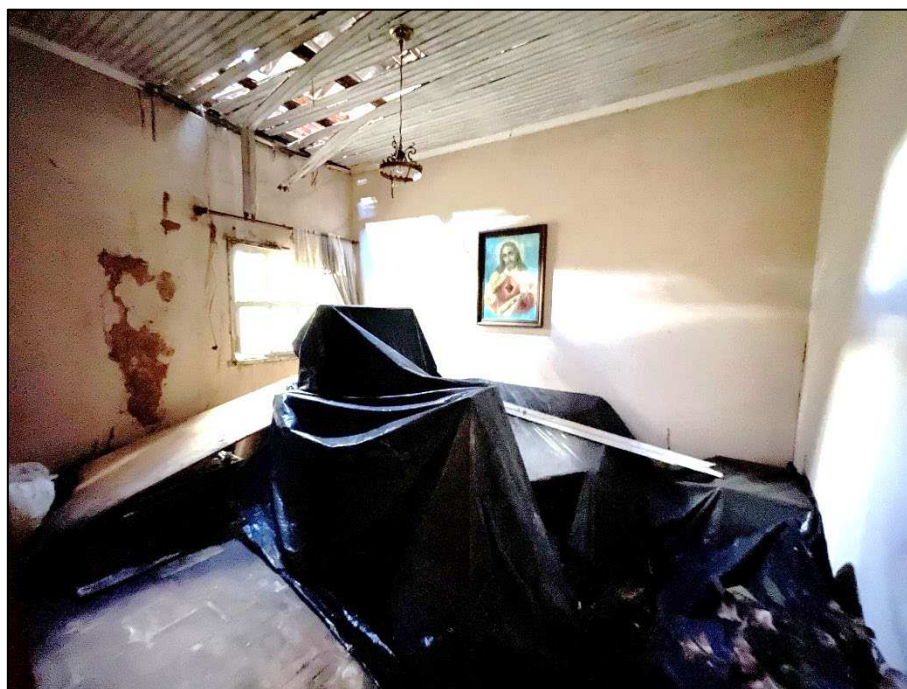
Rua Riachuelo, n.º 88 – Dormitório
